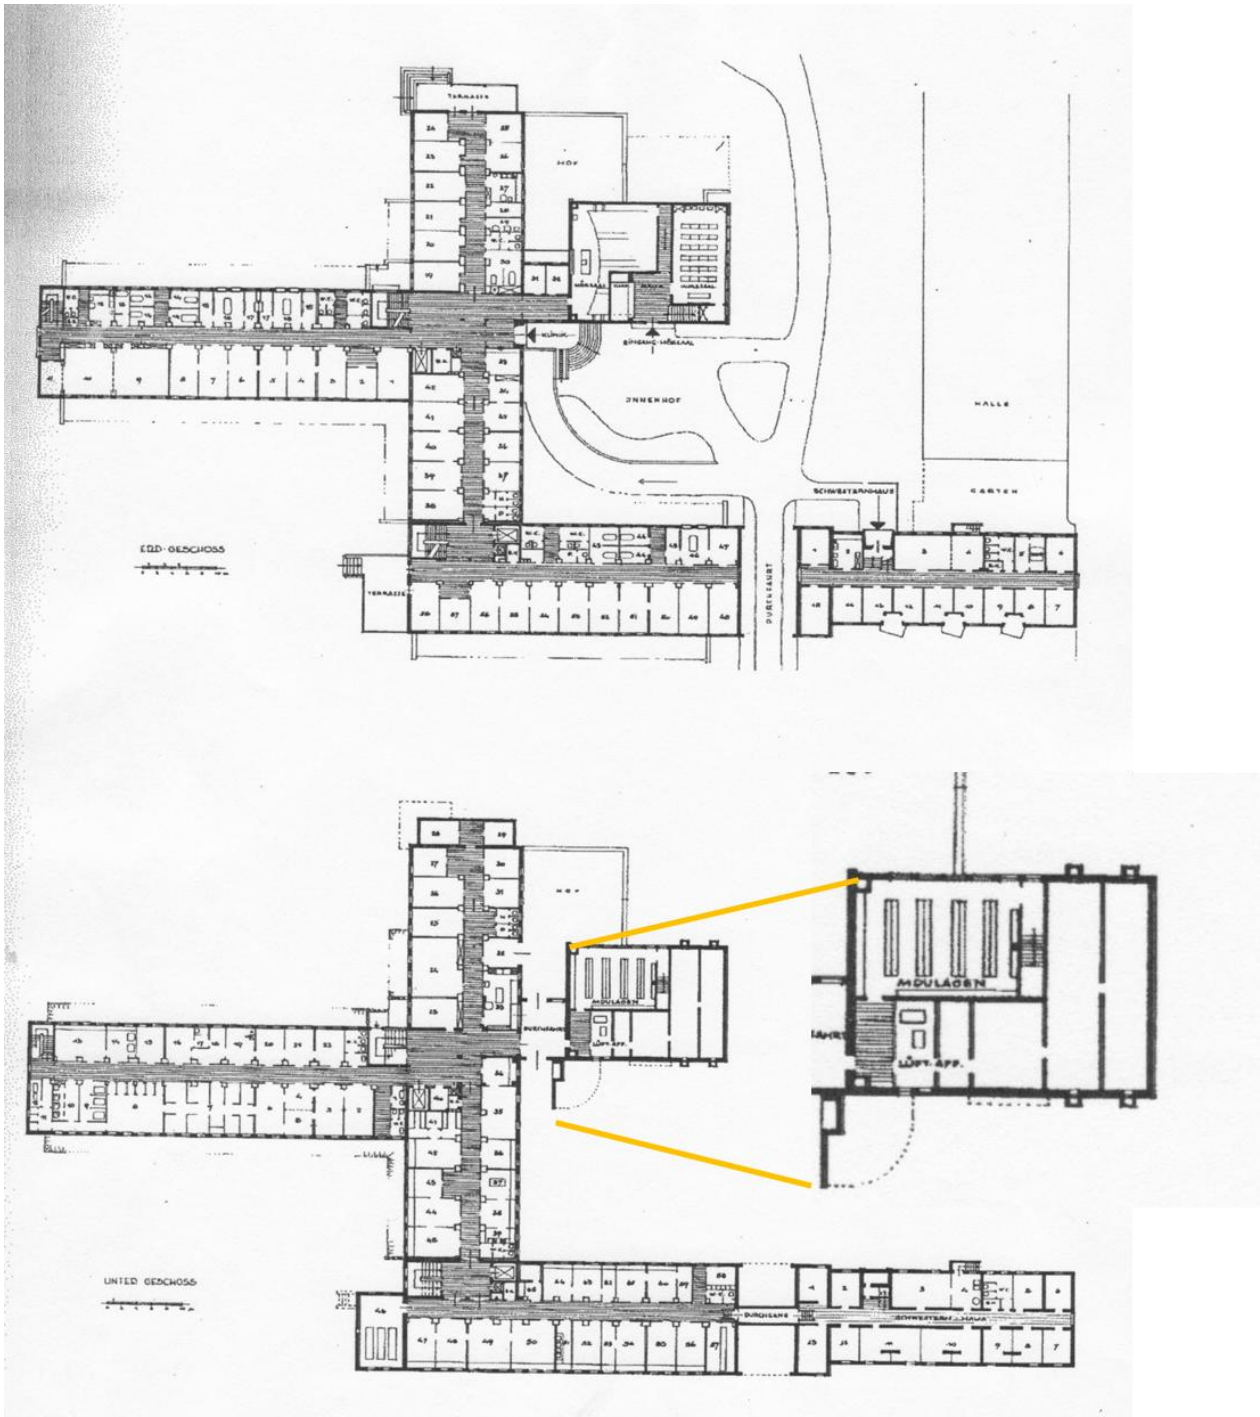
Grundriss der Hautklinik aus v. Holy et al. 1957, S. 236 mit Vergrößerung des alten Hörsaalgebäudes im Untergeschoss mit der Beschriftung „Moulagen“.
